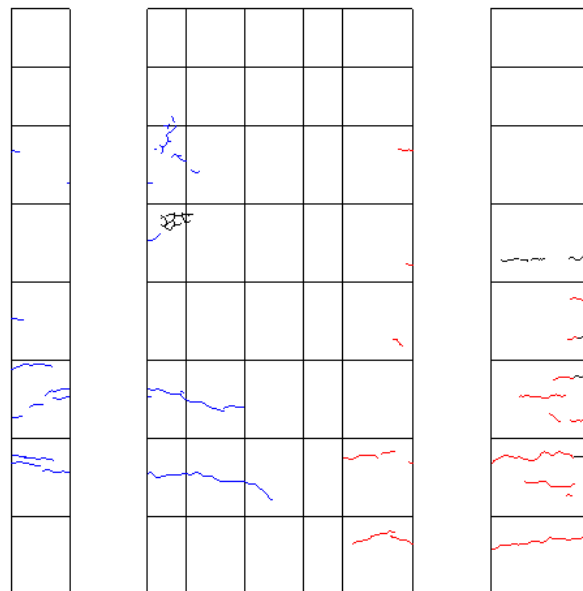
R=1/400 ひび割れ図
